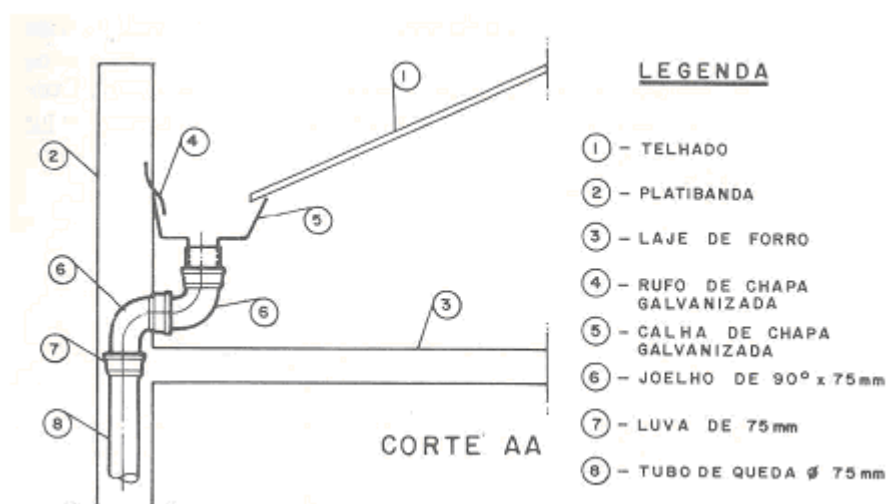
Ligação da Calha ao Tubo de Queda
